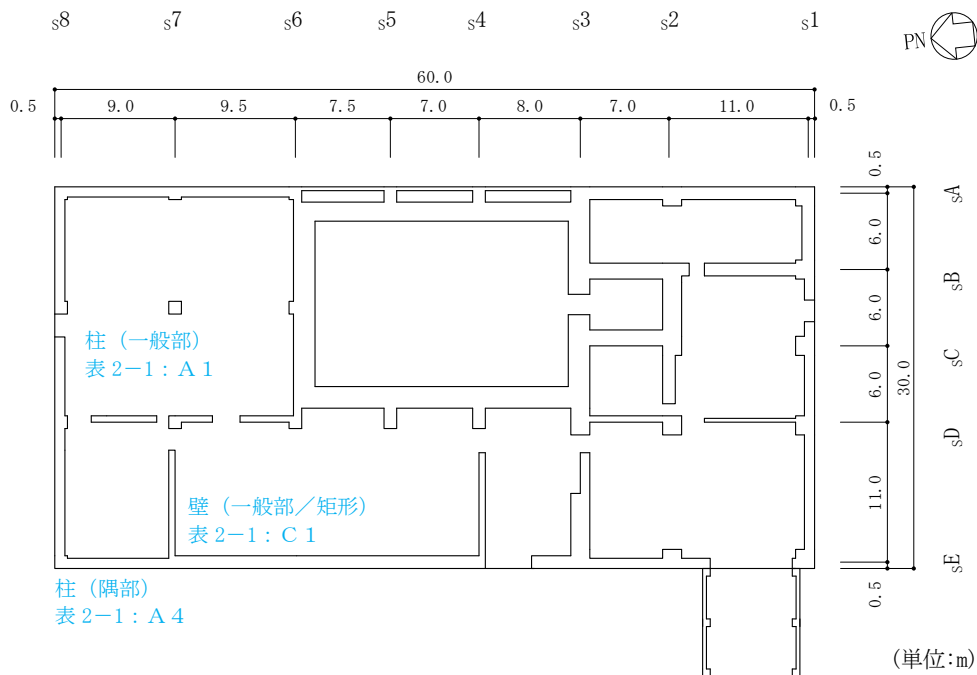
サイトバンカ建物の概略平面図 (EL 8.8m)
